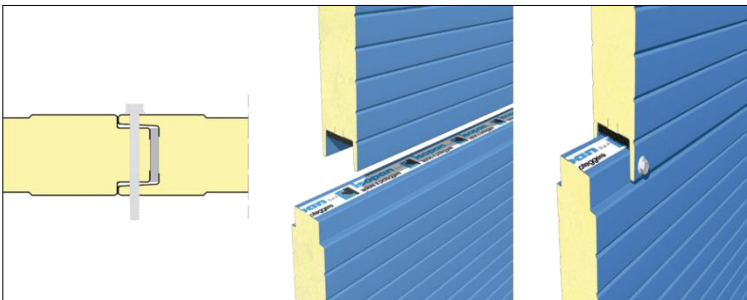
Panell amb sistema de fixació vista passant i junta únicament horitzontal.
